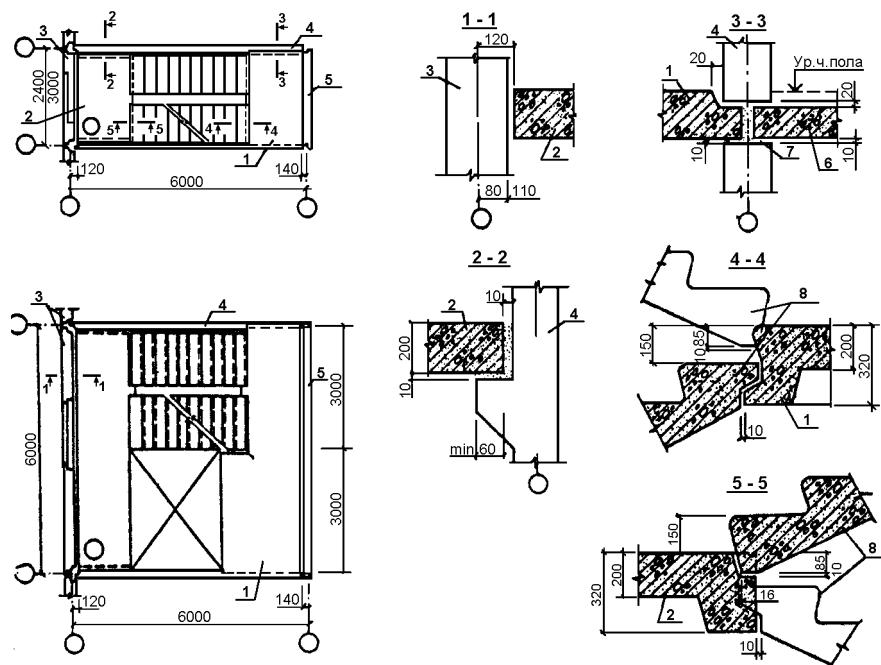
Монтажные схемы и узлы лестничных клеток в крупнопанельных бескаркасных зданиях.
